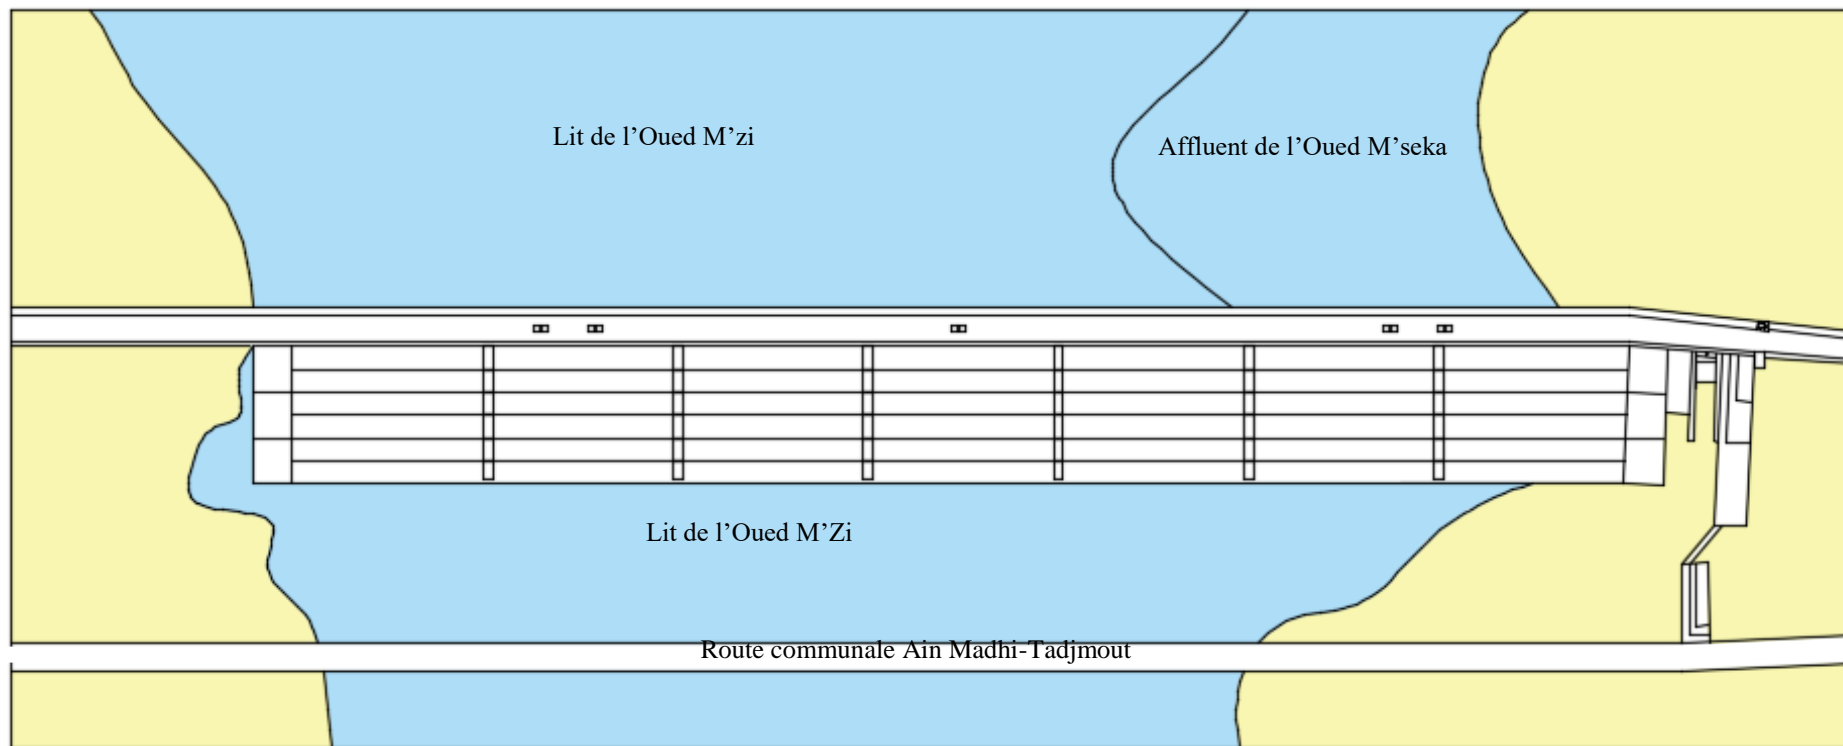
Schéma de vue en plan du barrage de Tadjmout
